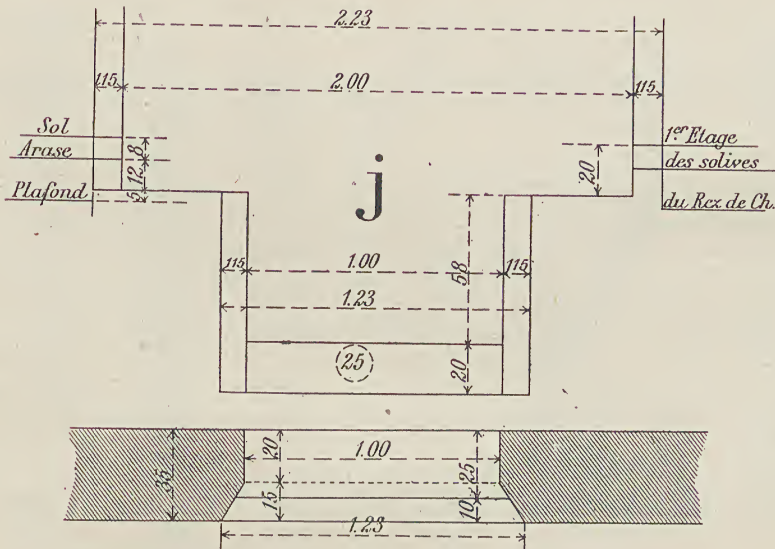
et 610. — Baie j: élévation intérieure et plan.
